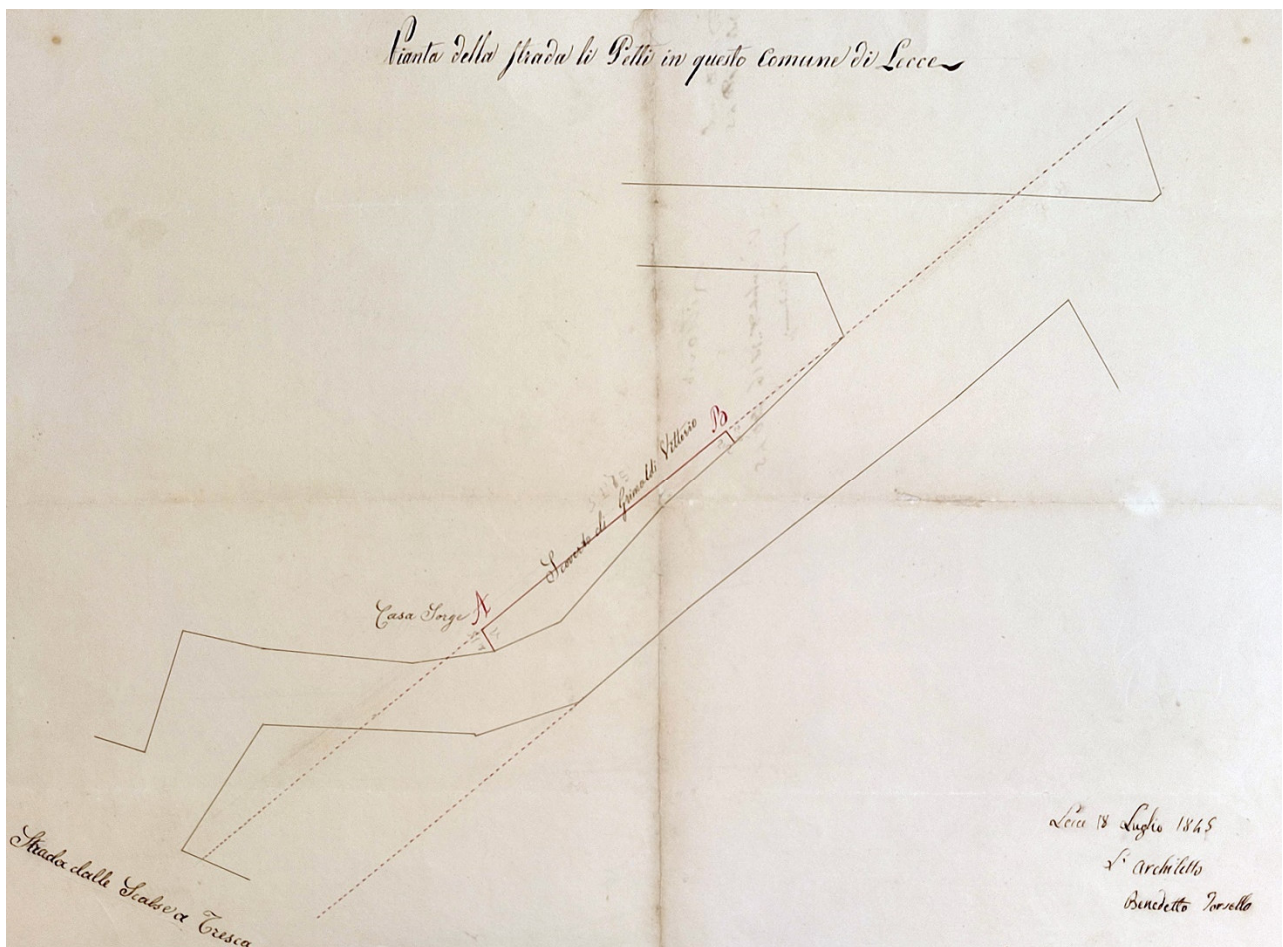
Pianta della strada Petti a Lecce, 1845 (ASL, Int. Aff. Part.ri)
